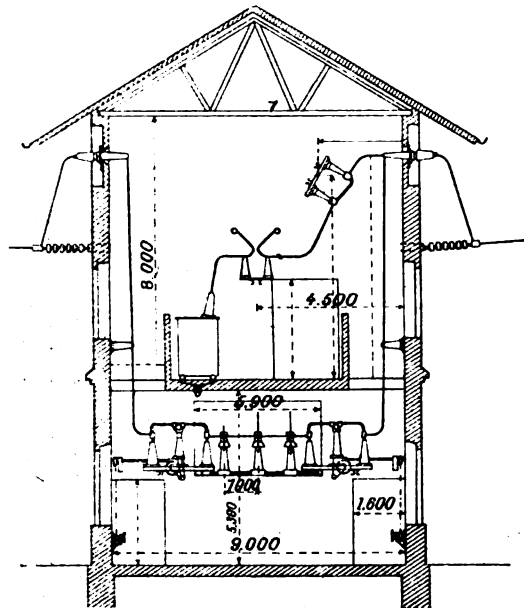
Poste de sectionnement 80 000 volts. Plans et coupes.
